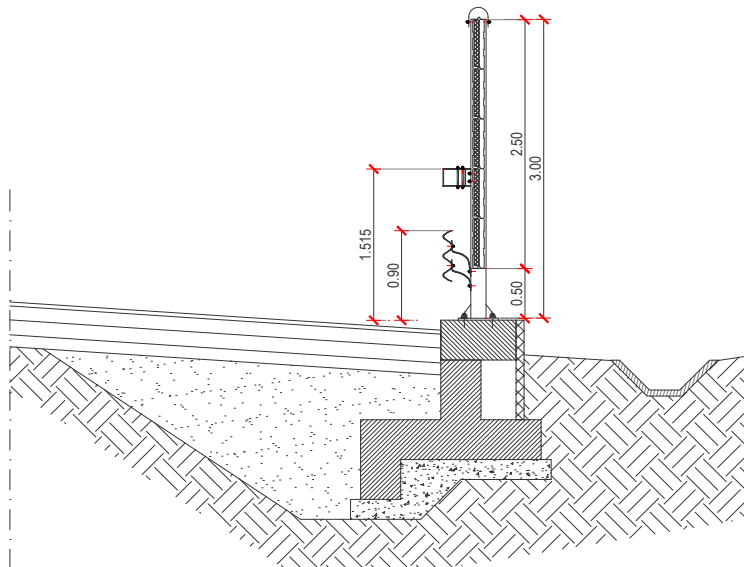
Sezione tipo di barriera con pannello fonoassorbente integrato con barriera di sicurezza (FAI).
